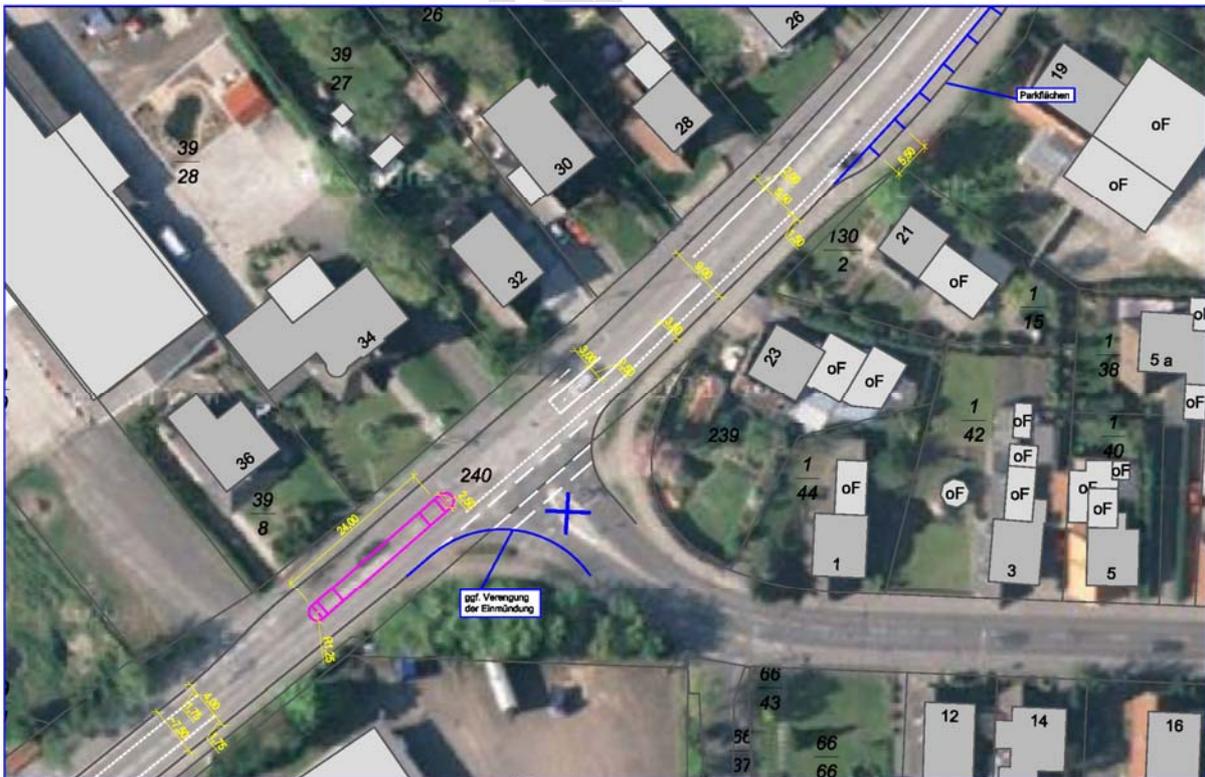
Ausschnitt Lageplan Marschstraße / Jungfernstieg / Marner Straße (Blatt 4)
